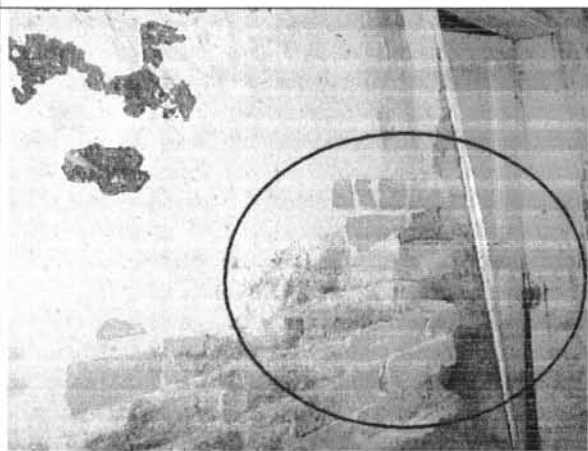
Hay desprendimiento y dislocación de las piezas de mampostería en los muros interiores.
